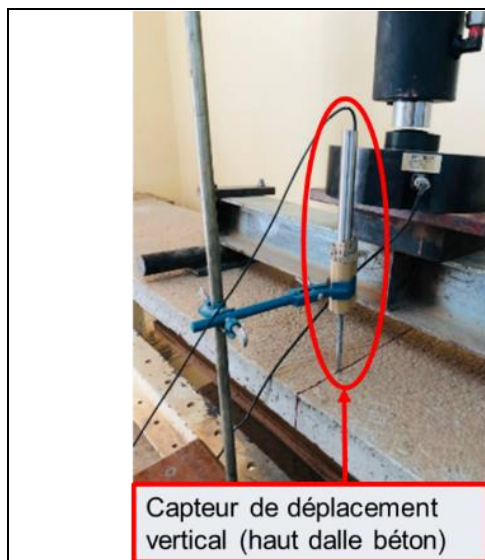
position du capteur de flèche sur la dalle de béton
